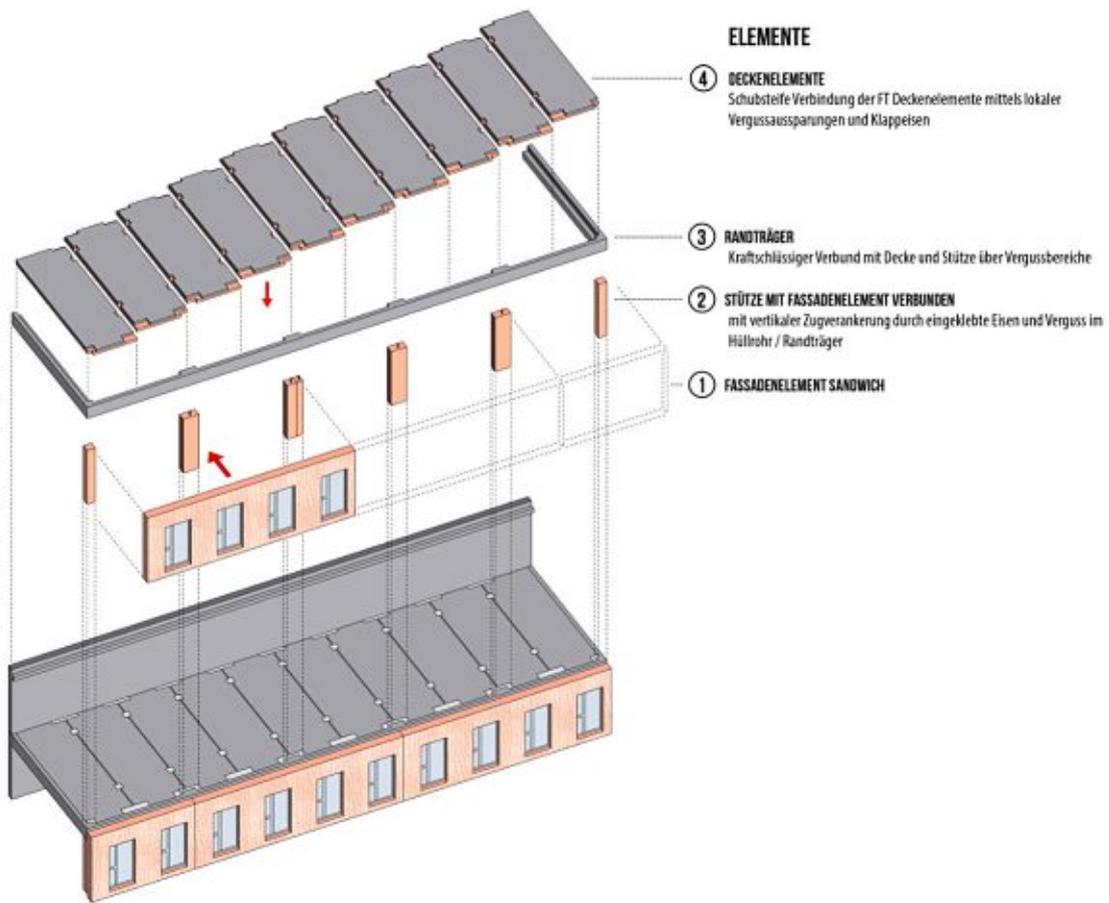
Explosionsgrafik der vorgefertigten Bauteile
